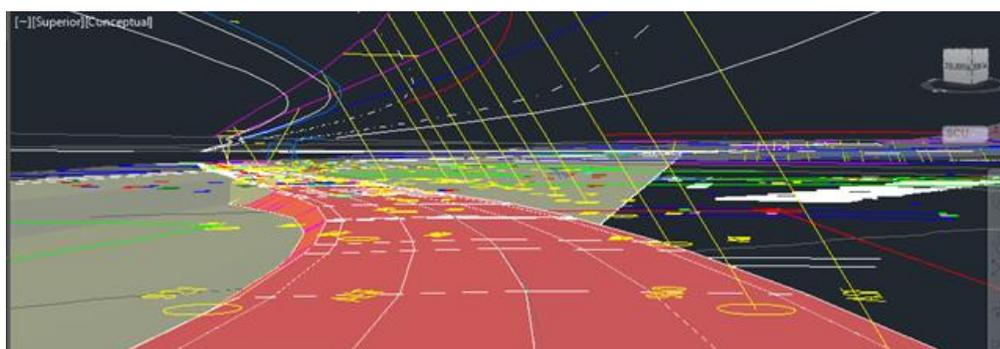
Vista Tridimensional de la Sección 1 en la Alternativa 1.
